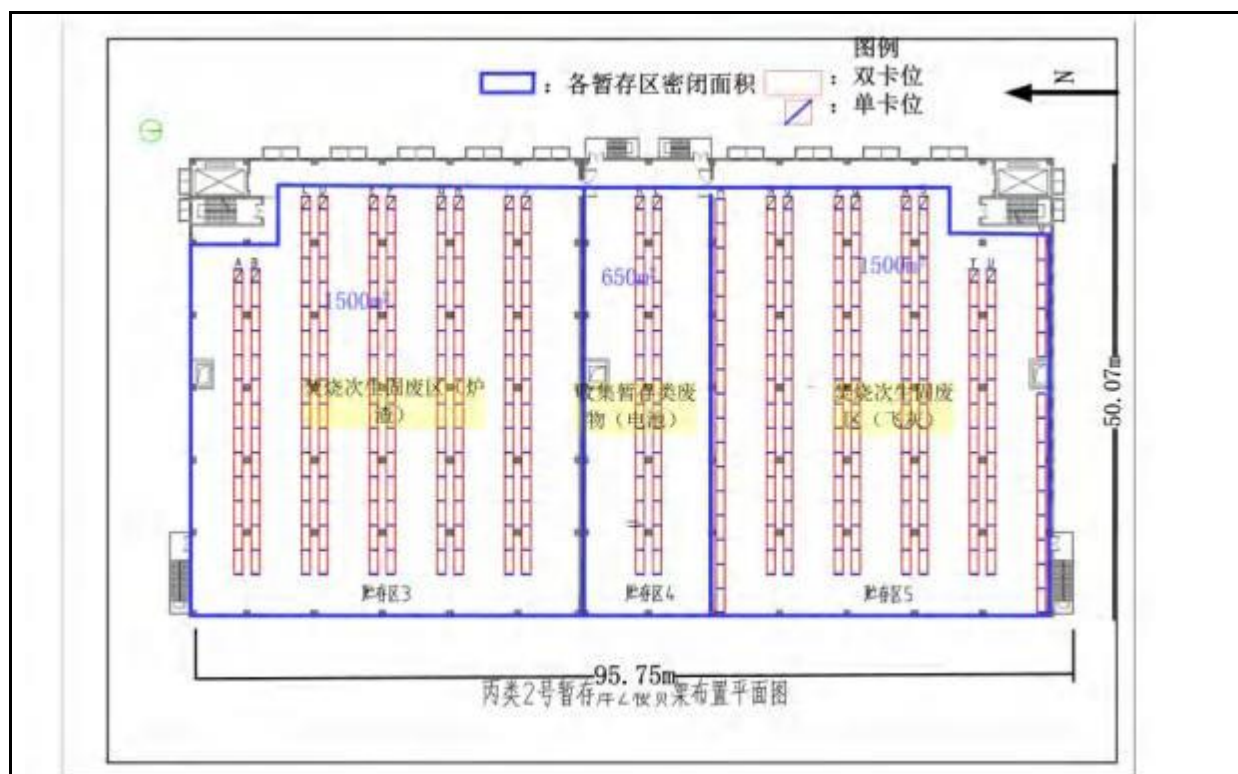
现有项目 2 号丙类暂存库 2 楼平面布置图
